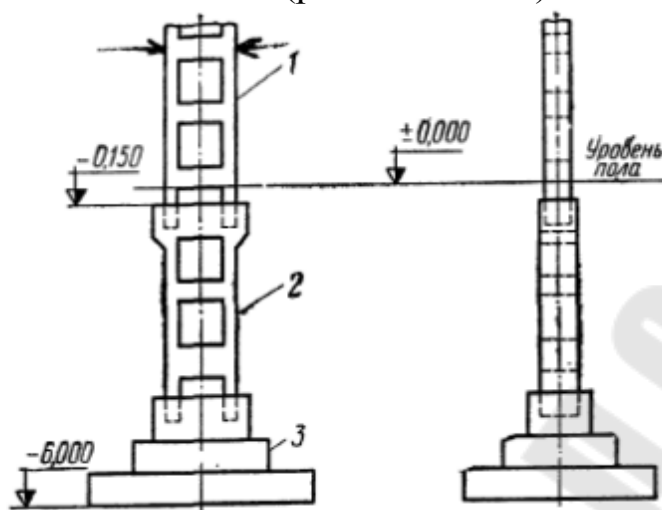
Схема соединения колонны, подколонника и фундамента
